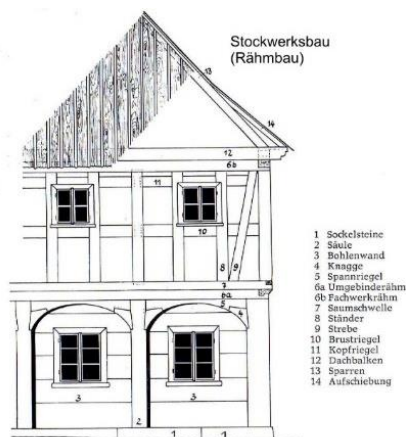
Construção tipo "umgebinderkonstruktion"
